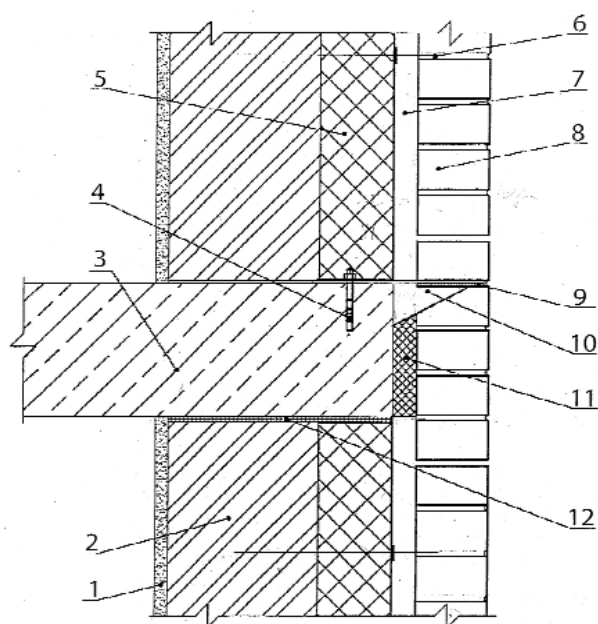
Фасади будинків з перекриттями, які виходять на фасад, без карнизів
